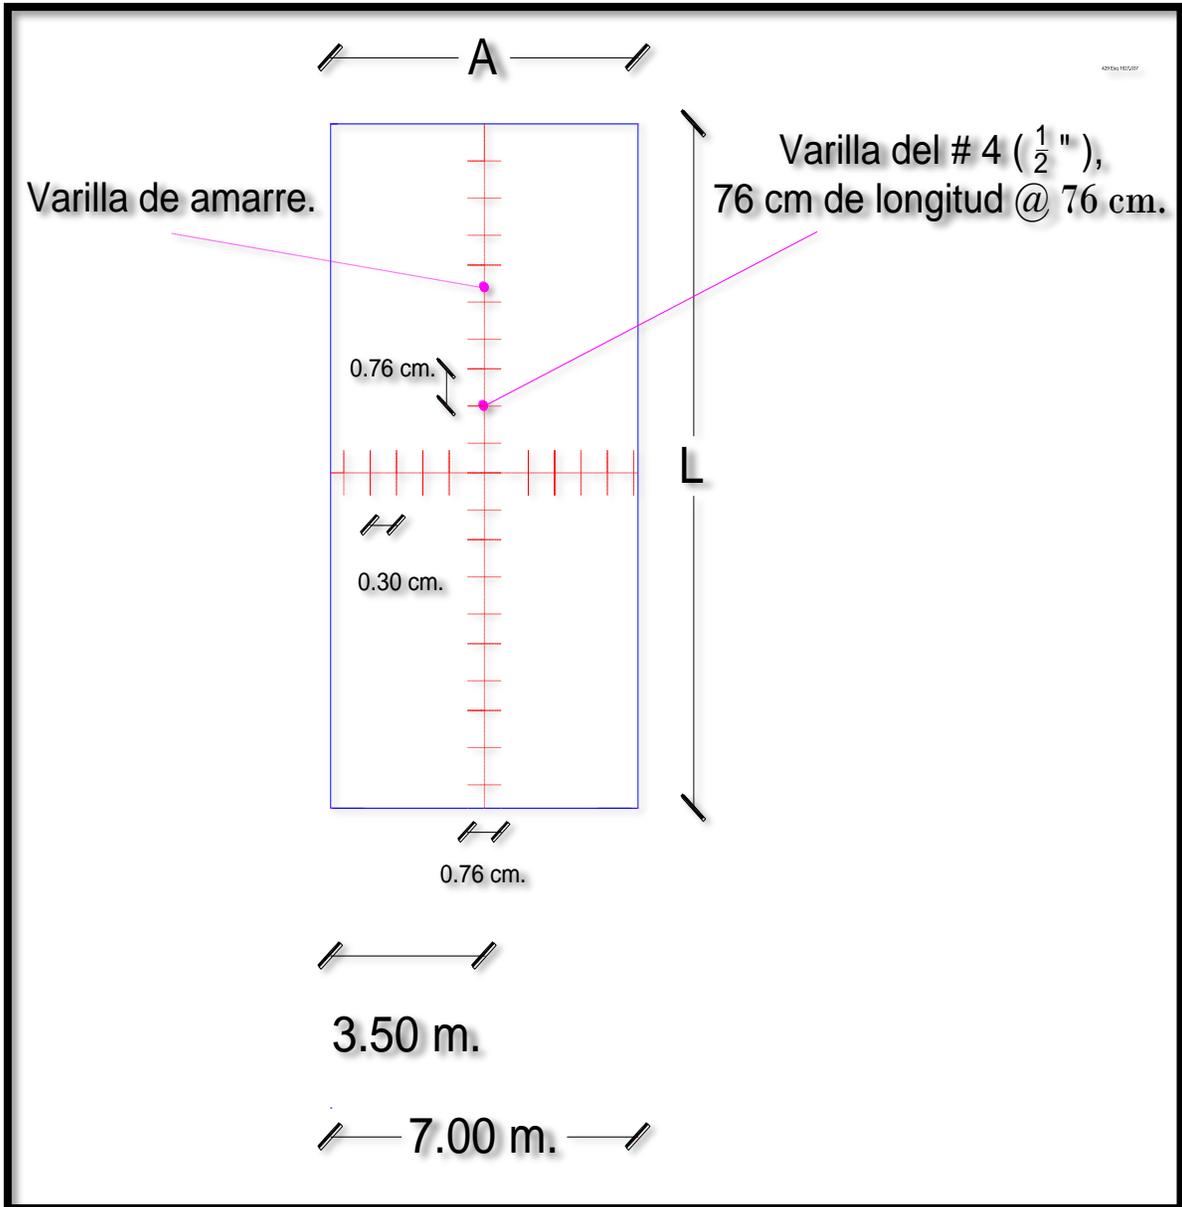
Juntas longitudinales para diseño de pavimento rígido.
